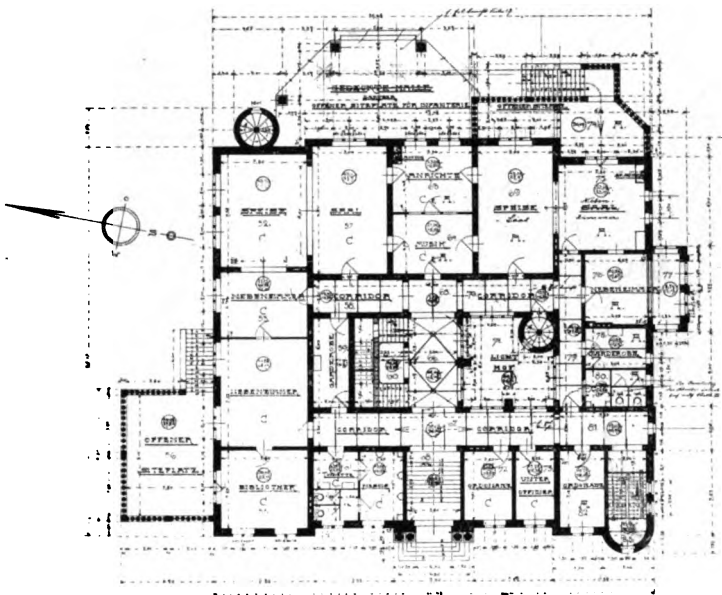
Offizier-Speiseanstalt. Erdgeschoss. 1:254.
